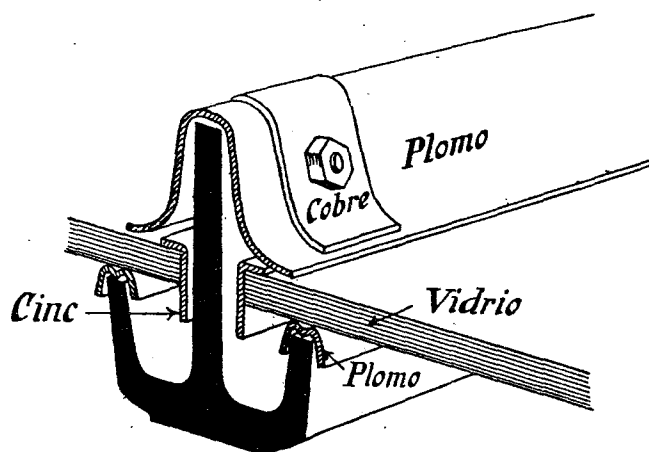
Hierro y junta, sistema Murat, para cubiertas de vidrio.
